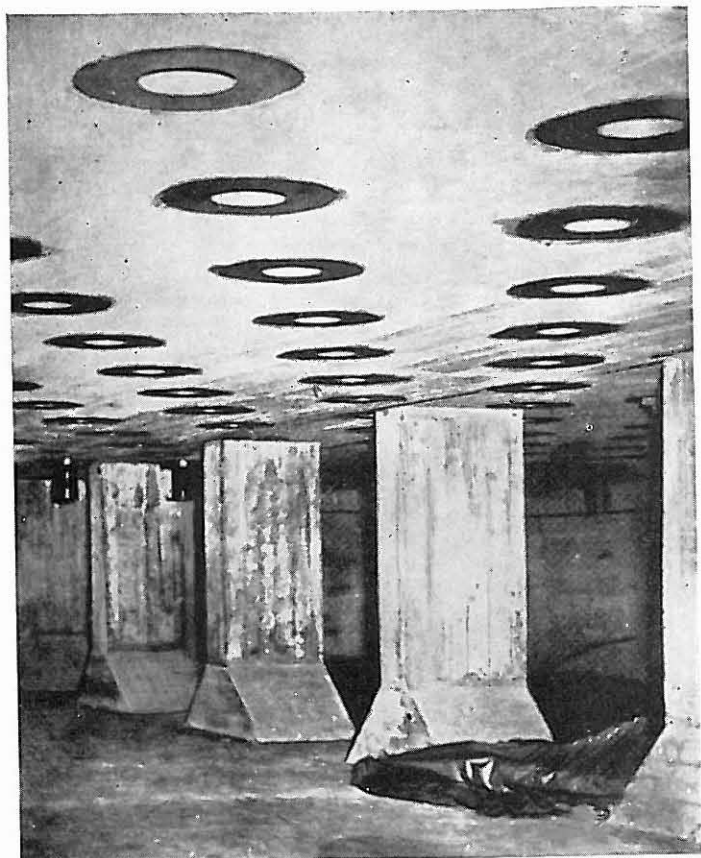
Untere Fläche der zur Versuchsanlage gehörenden Stahlbetonplatte
